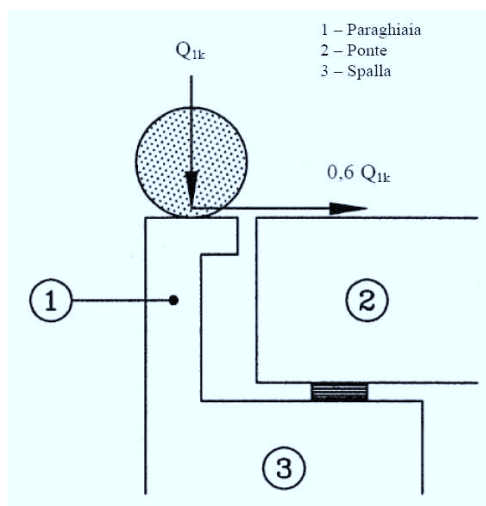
Carichi da traffico su muri paraghiaia
